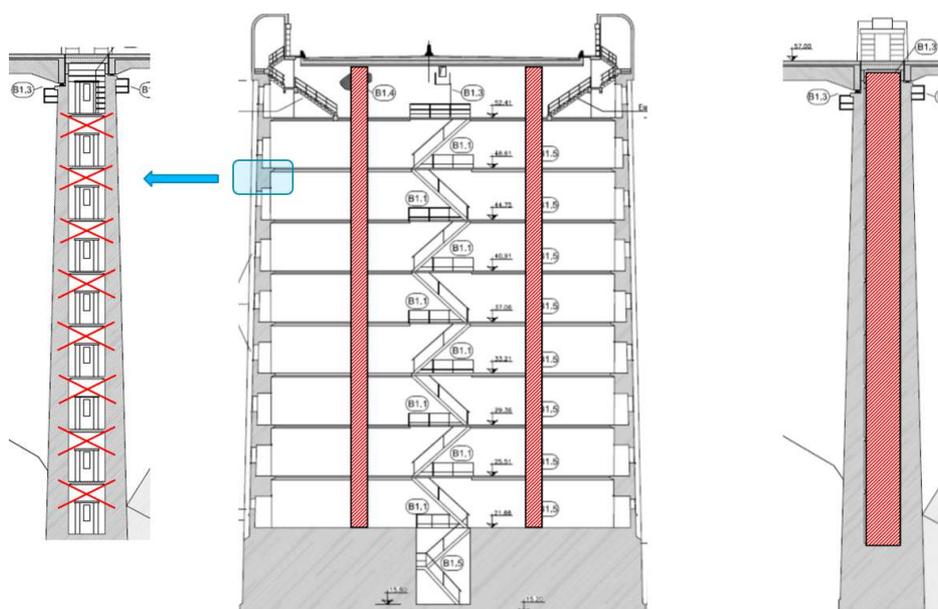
Reforço da ligação entre as paredes das pilstras – lintéis e paredes-diafragma.
